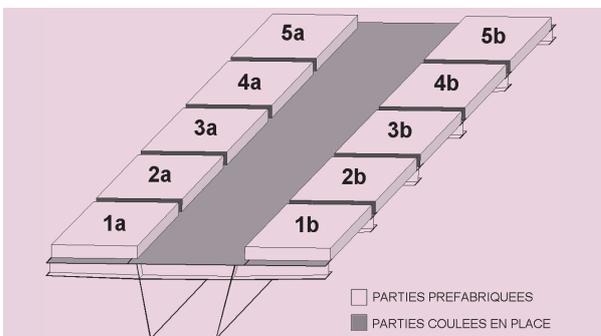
Répartition préfabrication/coulage en place pour un caisson fermé à pièces de pont avec consoles
